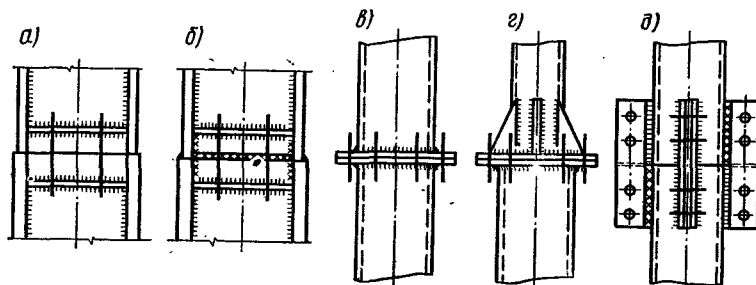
Варианты монтажных стыков колонн сплошного сечения
